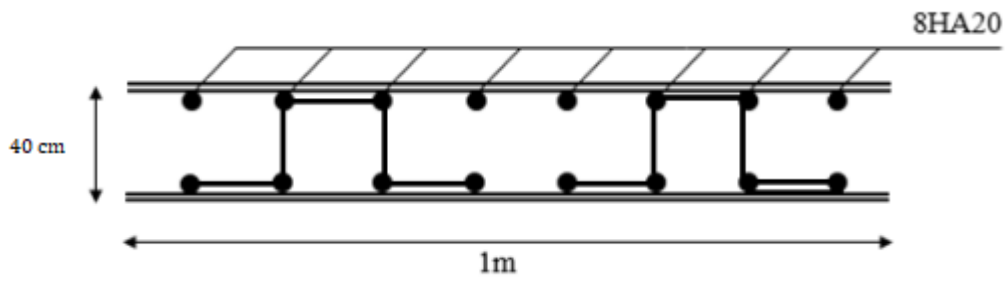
Ferrailage de la dalle du radier sens x-x
